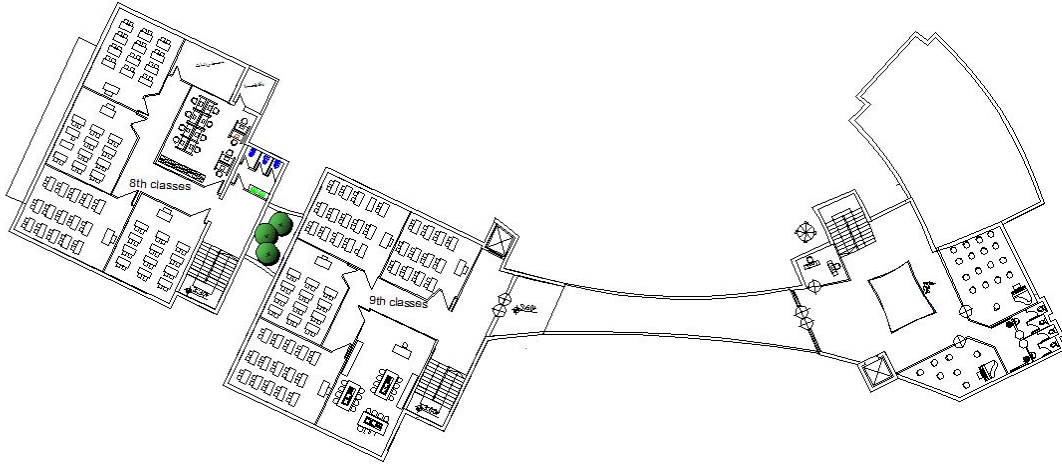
مخطط الطابق الأرضي للمعهد الموسيقي والمدرسة.
